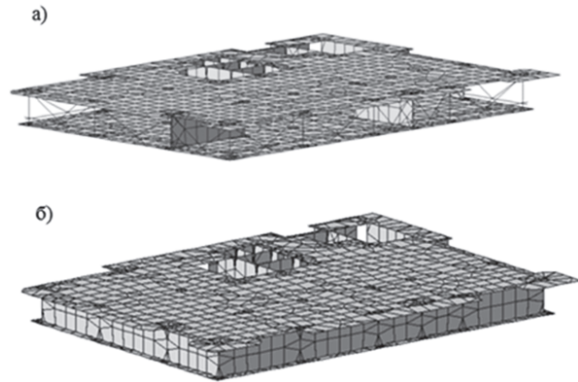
Расчетные схемы аутригерных этажей: а) в виде железобетонных ферм; б) в виде монолитных железобетонных стен
